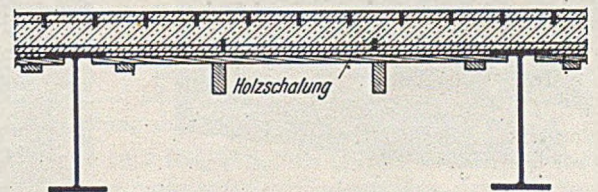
I-Trägerrost mit Betonfüllung ohne Bodenblech. Schalungskonstruktion.
